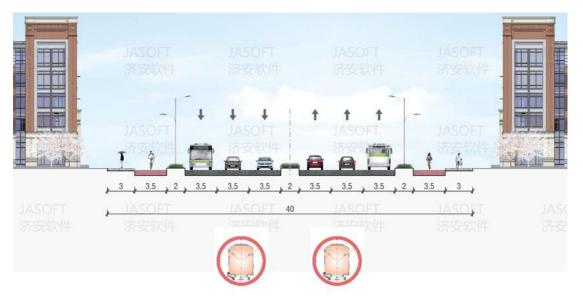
线路沿鲥鱼港路敷设横断面示意图
